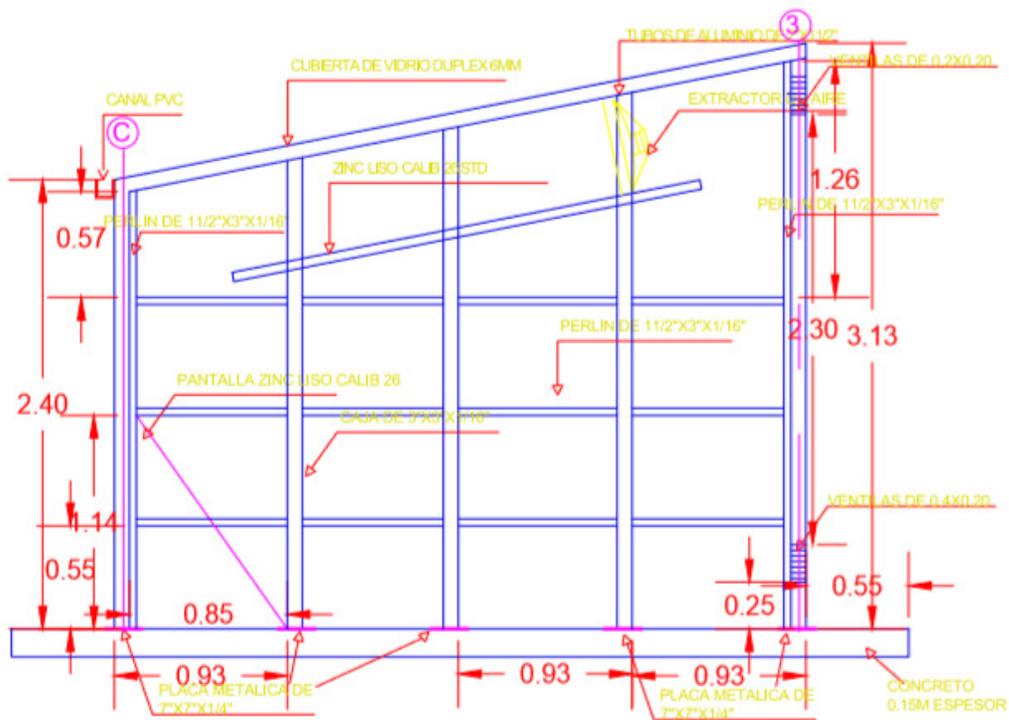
Elevación estructural lado B, Fuente: PIMA.
